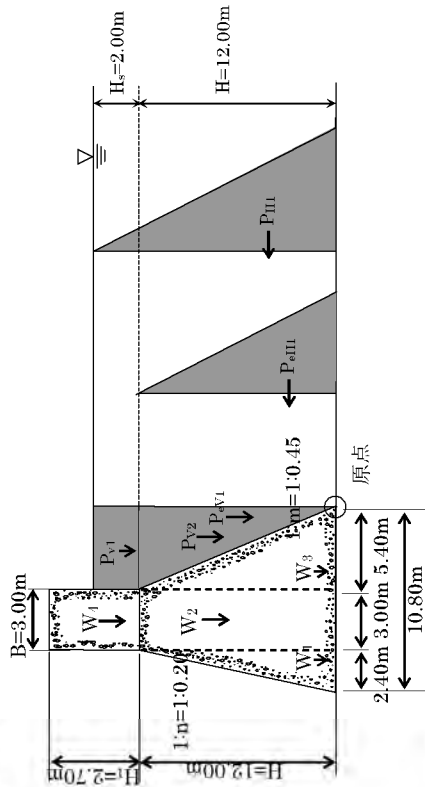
砂防堰堤に作用する力 (断面 (2) : 土石流捕捉後の湛水時)
